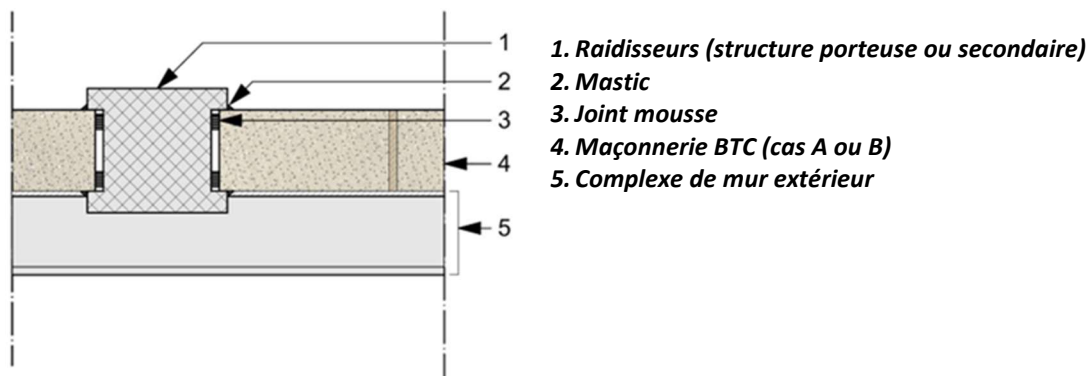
Exemple de détail en plan de la liaison entre maçonnerie et poteau d'ossature avec joint mousse (cas A ou B)
